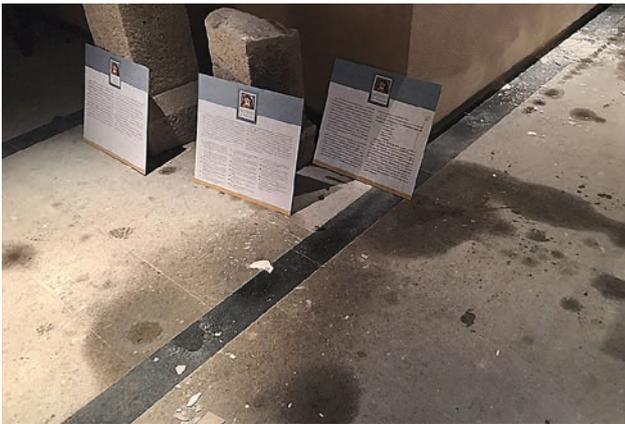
Tracce di umidità ed acqua sul pavimento dell'anticamera al mitreo; stato ante operam (Foto di C. Carocci)
